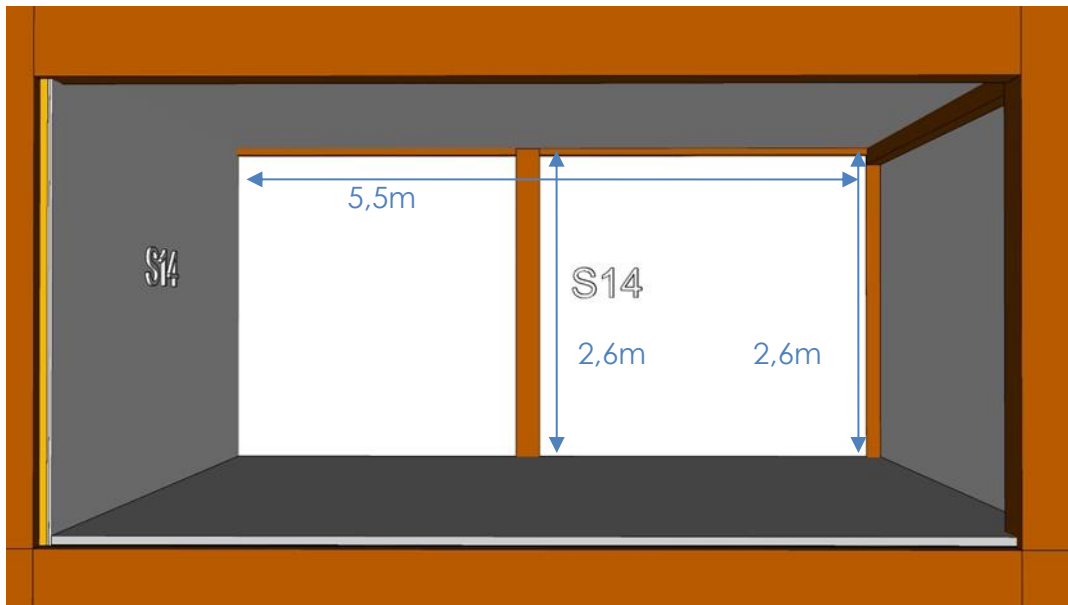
Vue du local S14 avec les poutres et poteaux apparents.
